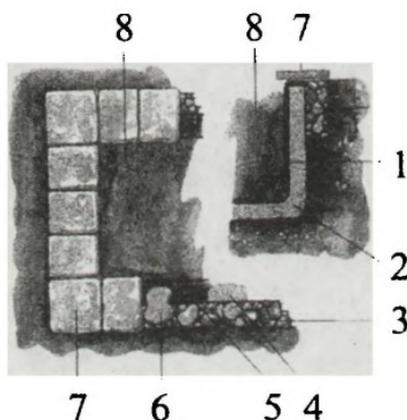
Формальный водоём из жёсткой формы (вид сверху и в разрезе): 1 – стекловолоконное покрытие; 2 – песок; 3 – слой гальки; 4 – песок; 5 – край водоёма; 6 – строительный раствор; 7 – плиты бетонные; 8 – вода
